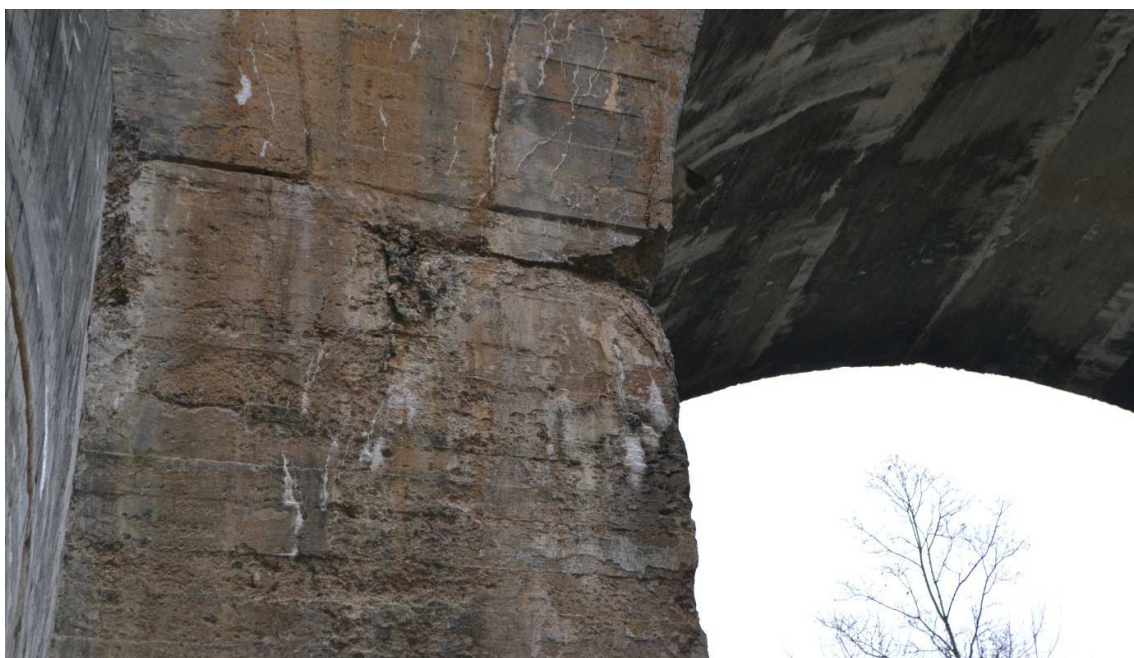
Zamakanje, zasiganost in razpadanje in krušenje betona
